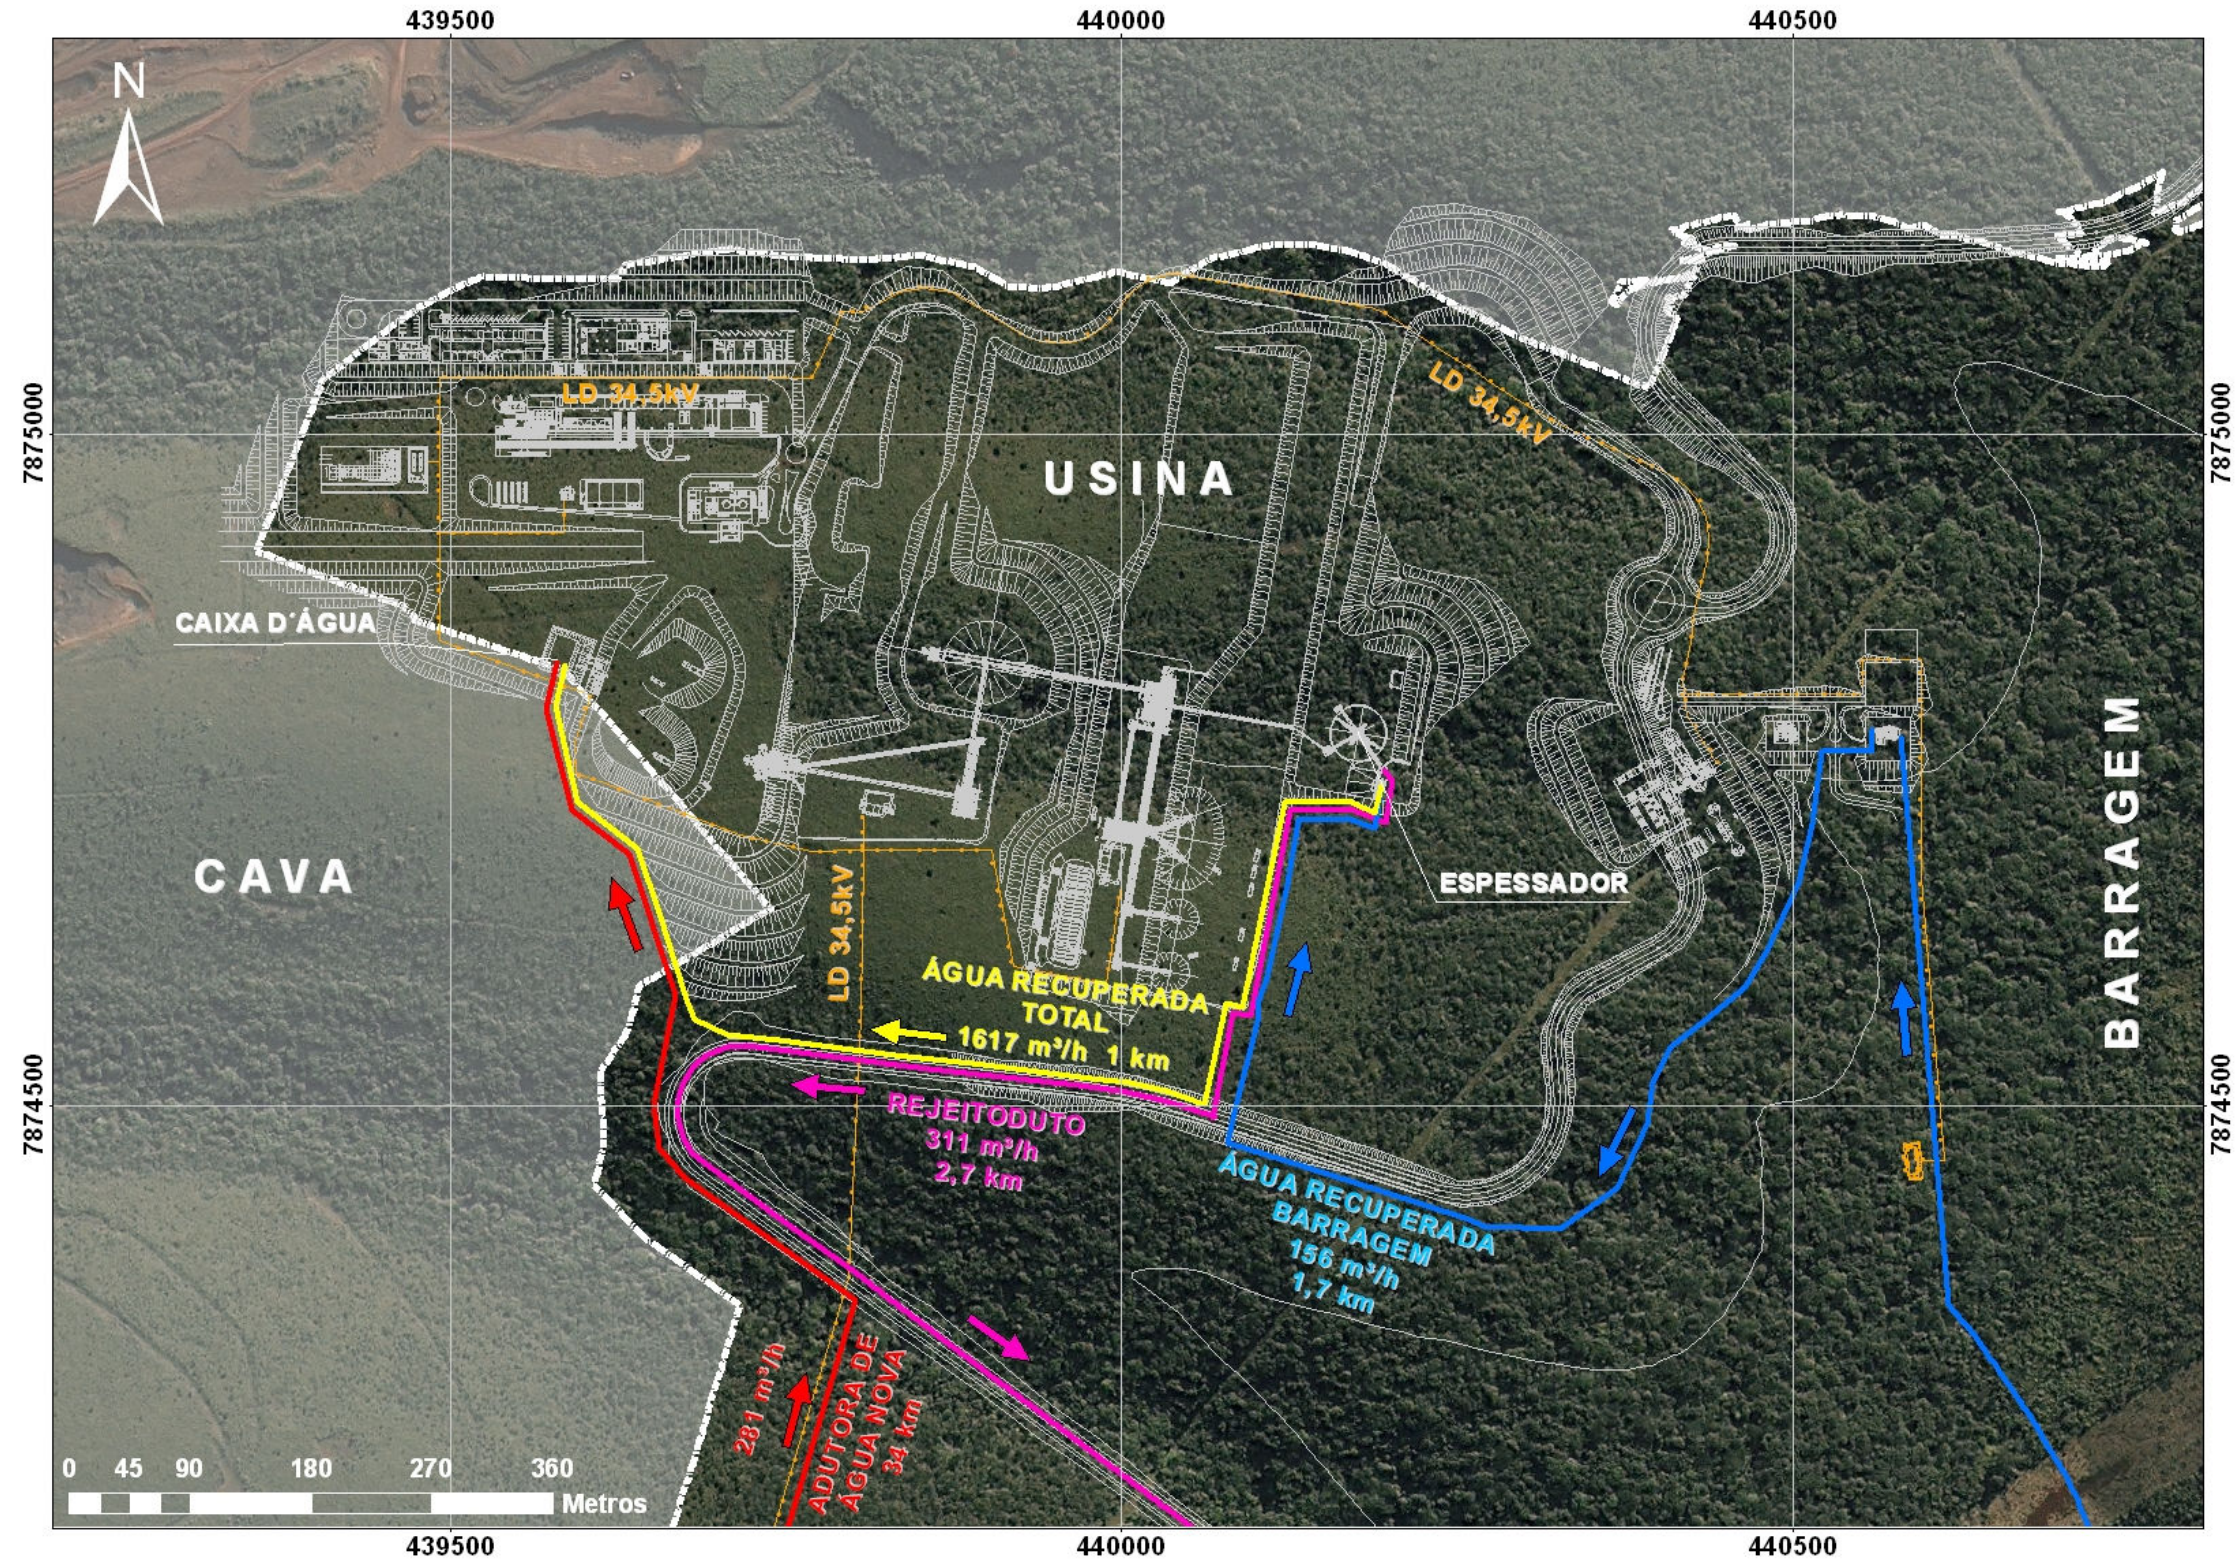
Nova planta e respectivo sistema de tubulações de água.
